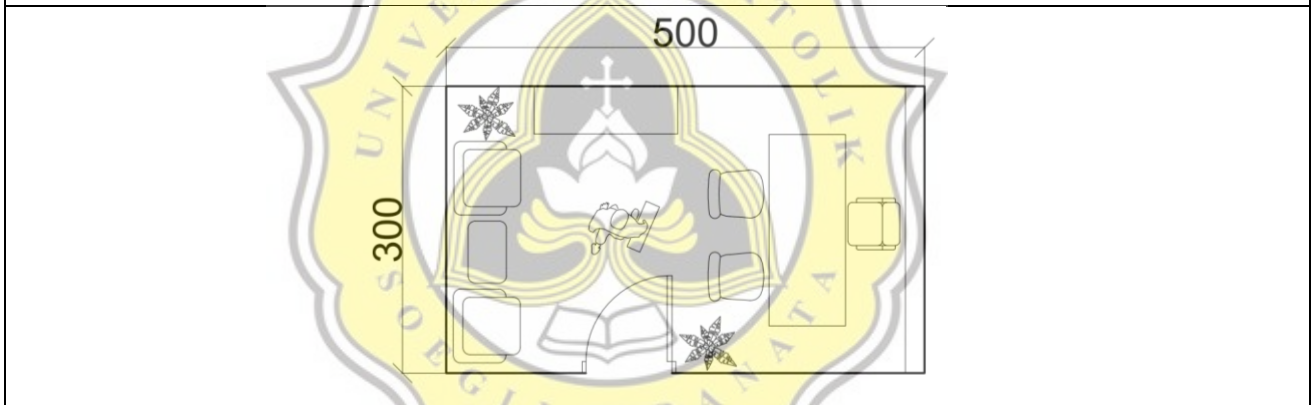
44 Layout Ruang Istirahat Karyawan
